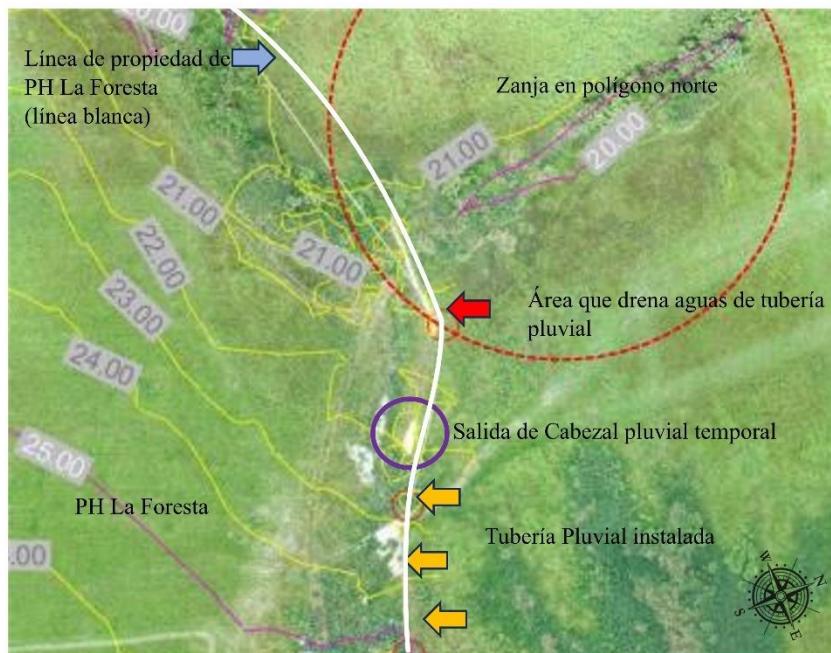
Vista de tubería pluvial del desarrollo de Santa Mónica
